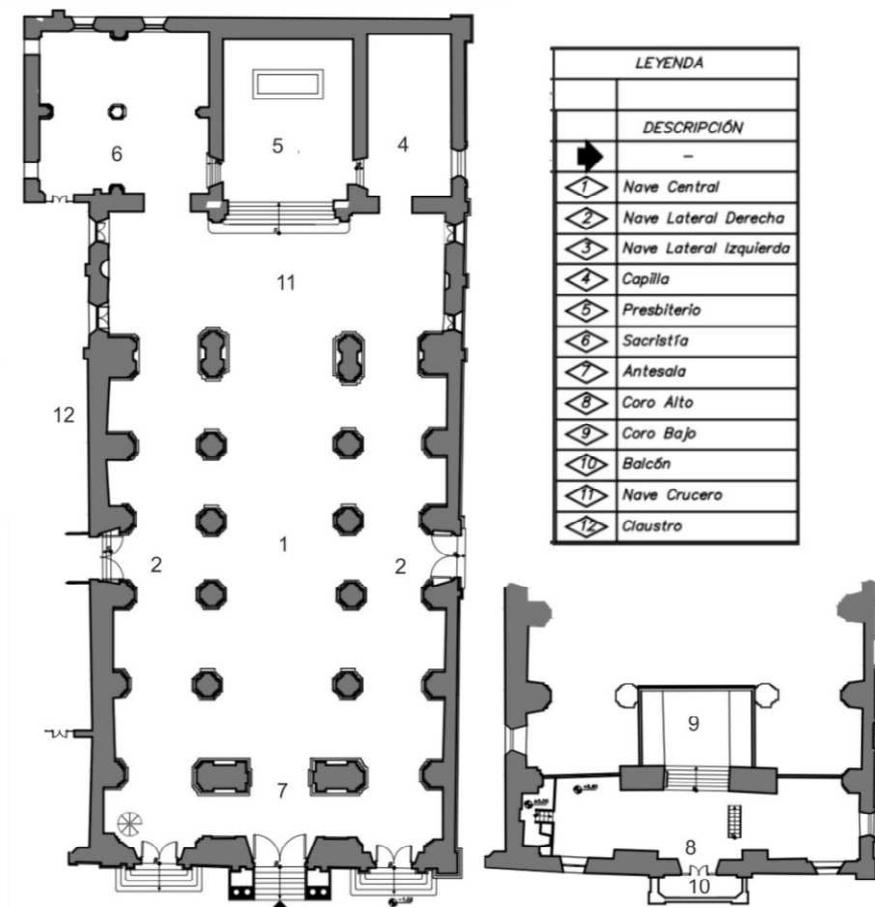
Plantas arquitectónicas de la iglesia y el coro. 2016. Fuente: Planos del autor.
